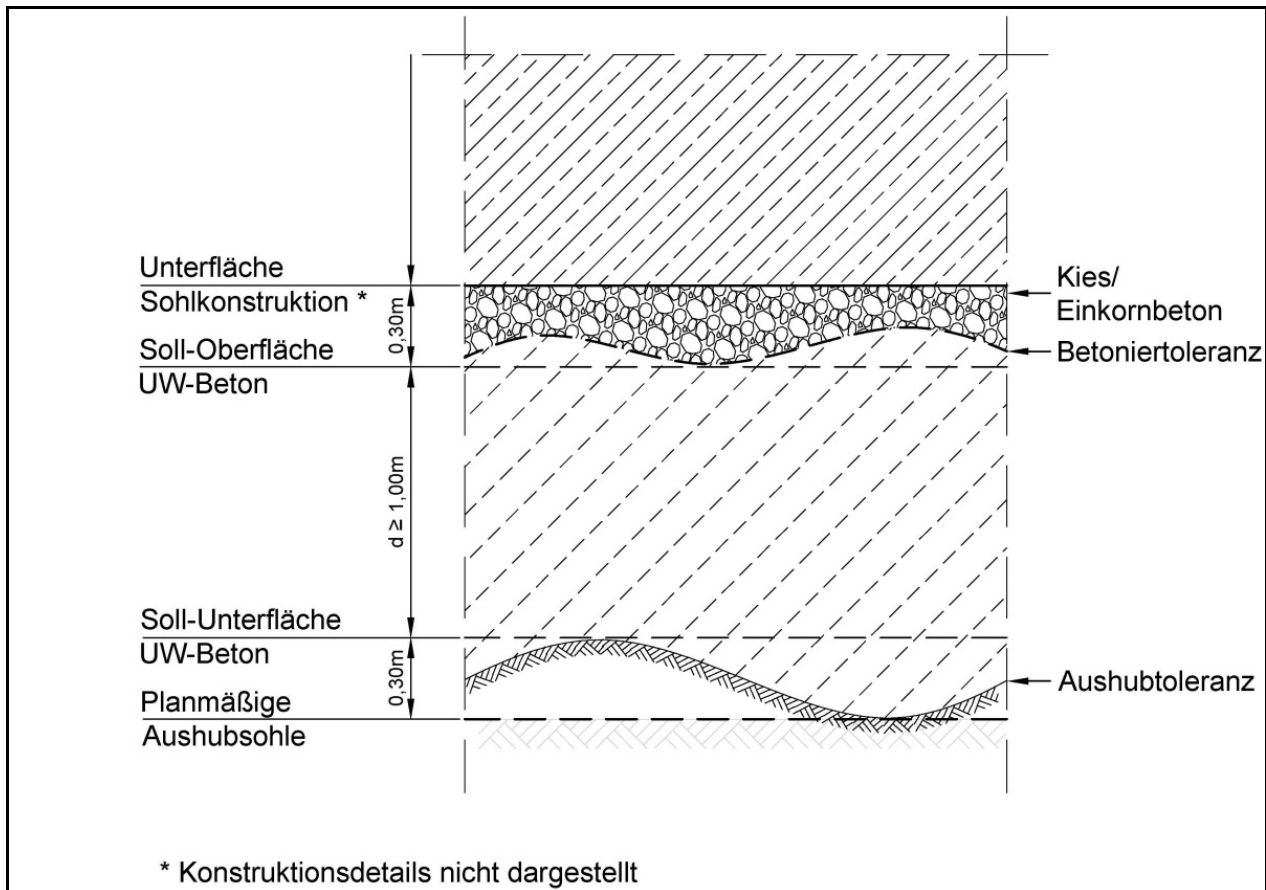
Darstellung der Ausführungssituation für eine Unterwasserbetonsohle
